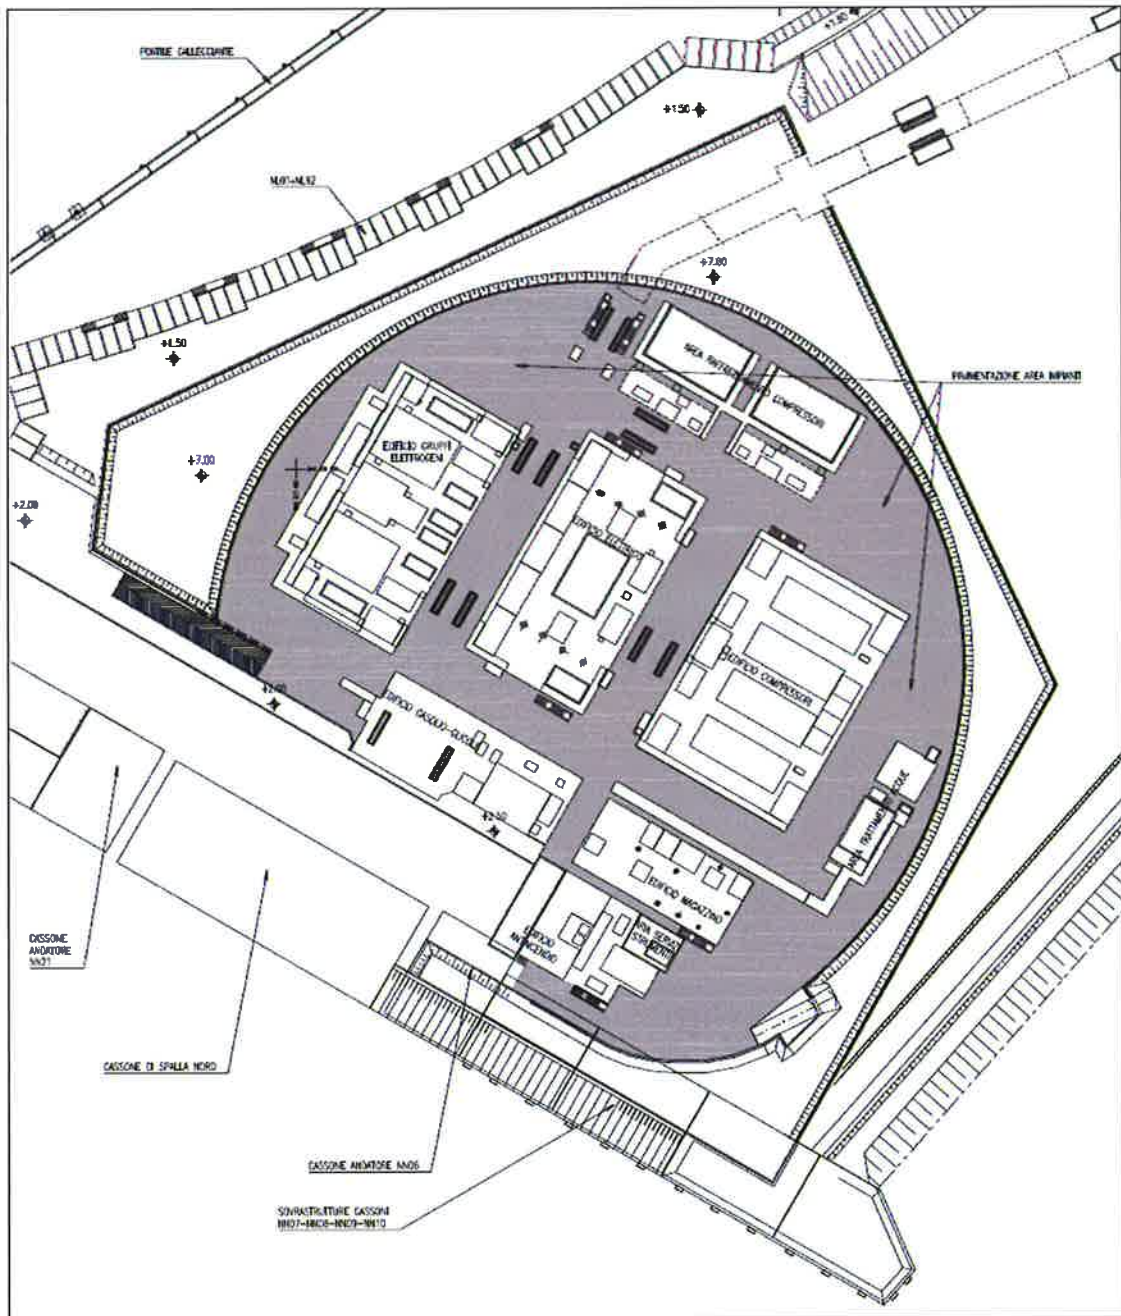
PLANIMETRIA DI SPALLA NORD
